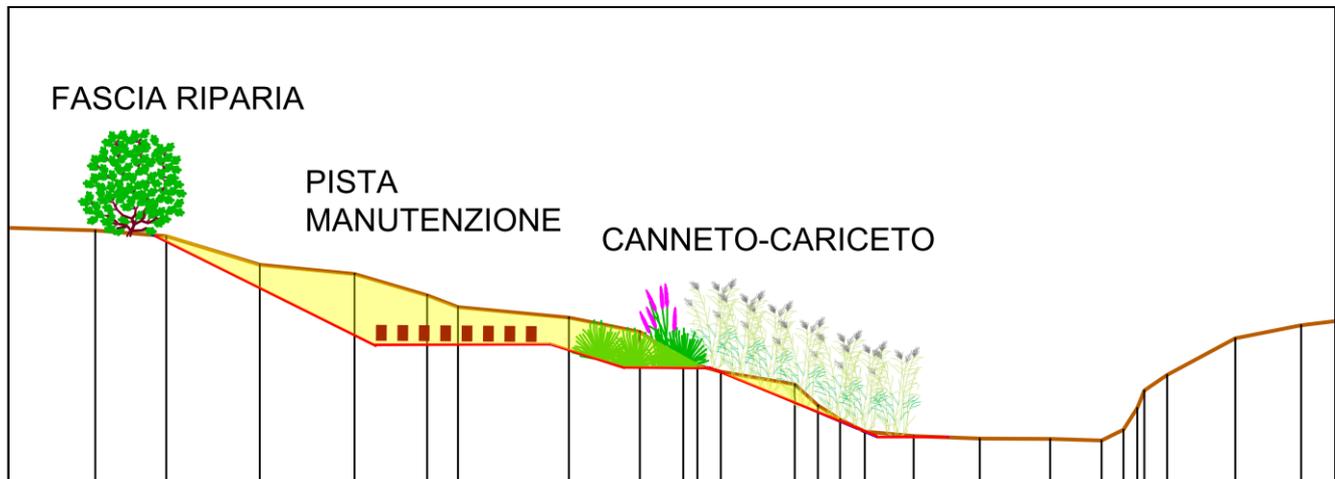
Sezione tipologica di progetto applicata al secondo sub-tratto del Tratto 1, tra il ponte degli Inglesi e il ponte di via Remesina, per una lunghezza di 200 m. In marrone è indicata la sezione rilevata nello stato attuale, in rosso la sezione di progetto e in giallo l'area di sbancamento.
